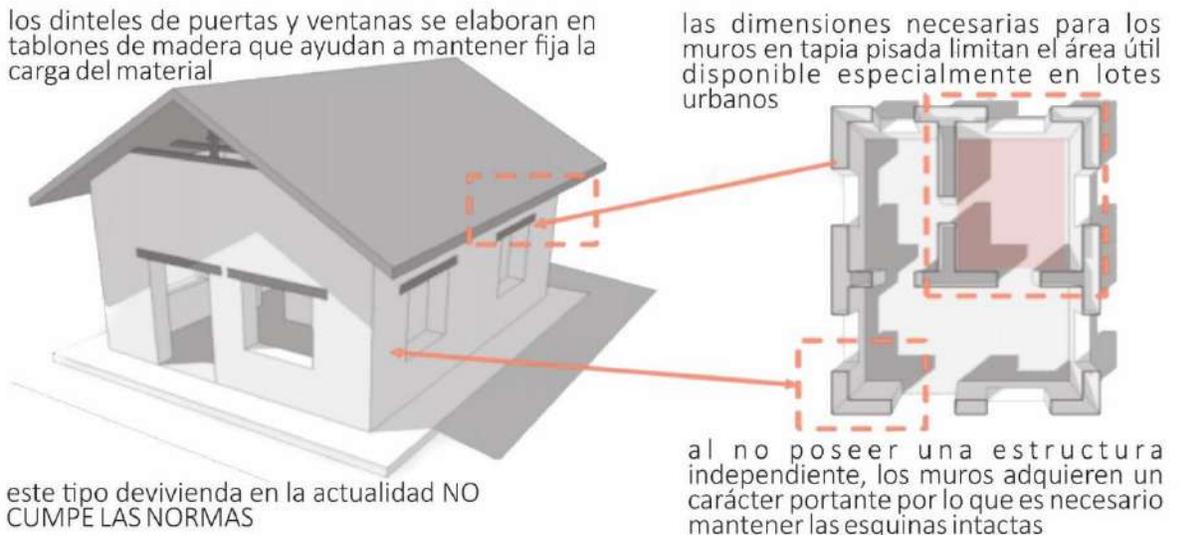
vivienda en Tapia Fuente: <https://fundaciontierraviva.org/2009/11/casa-pena> Construcción de Vivienda en Tapia en Bucaramanga,
